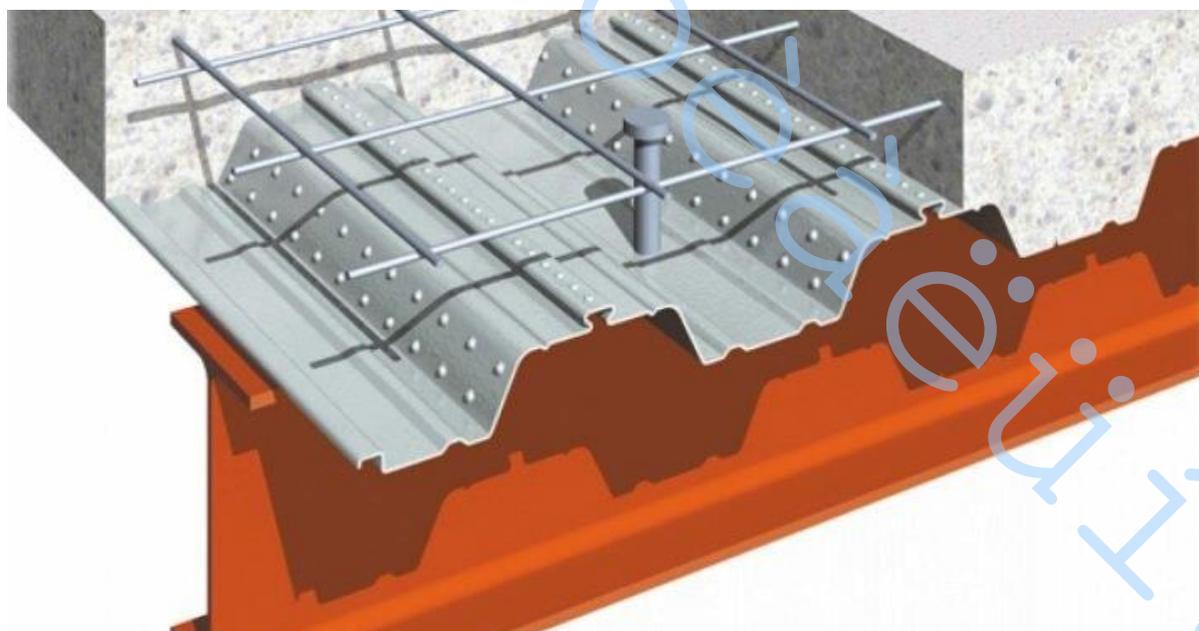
Перекрытие по металлическим балкам методом «несъемной опалубки» (регламентируется СНиП II-23-81)
